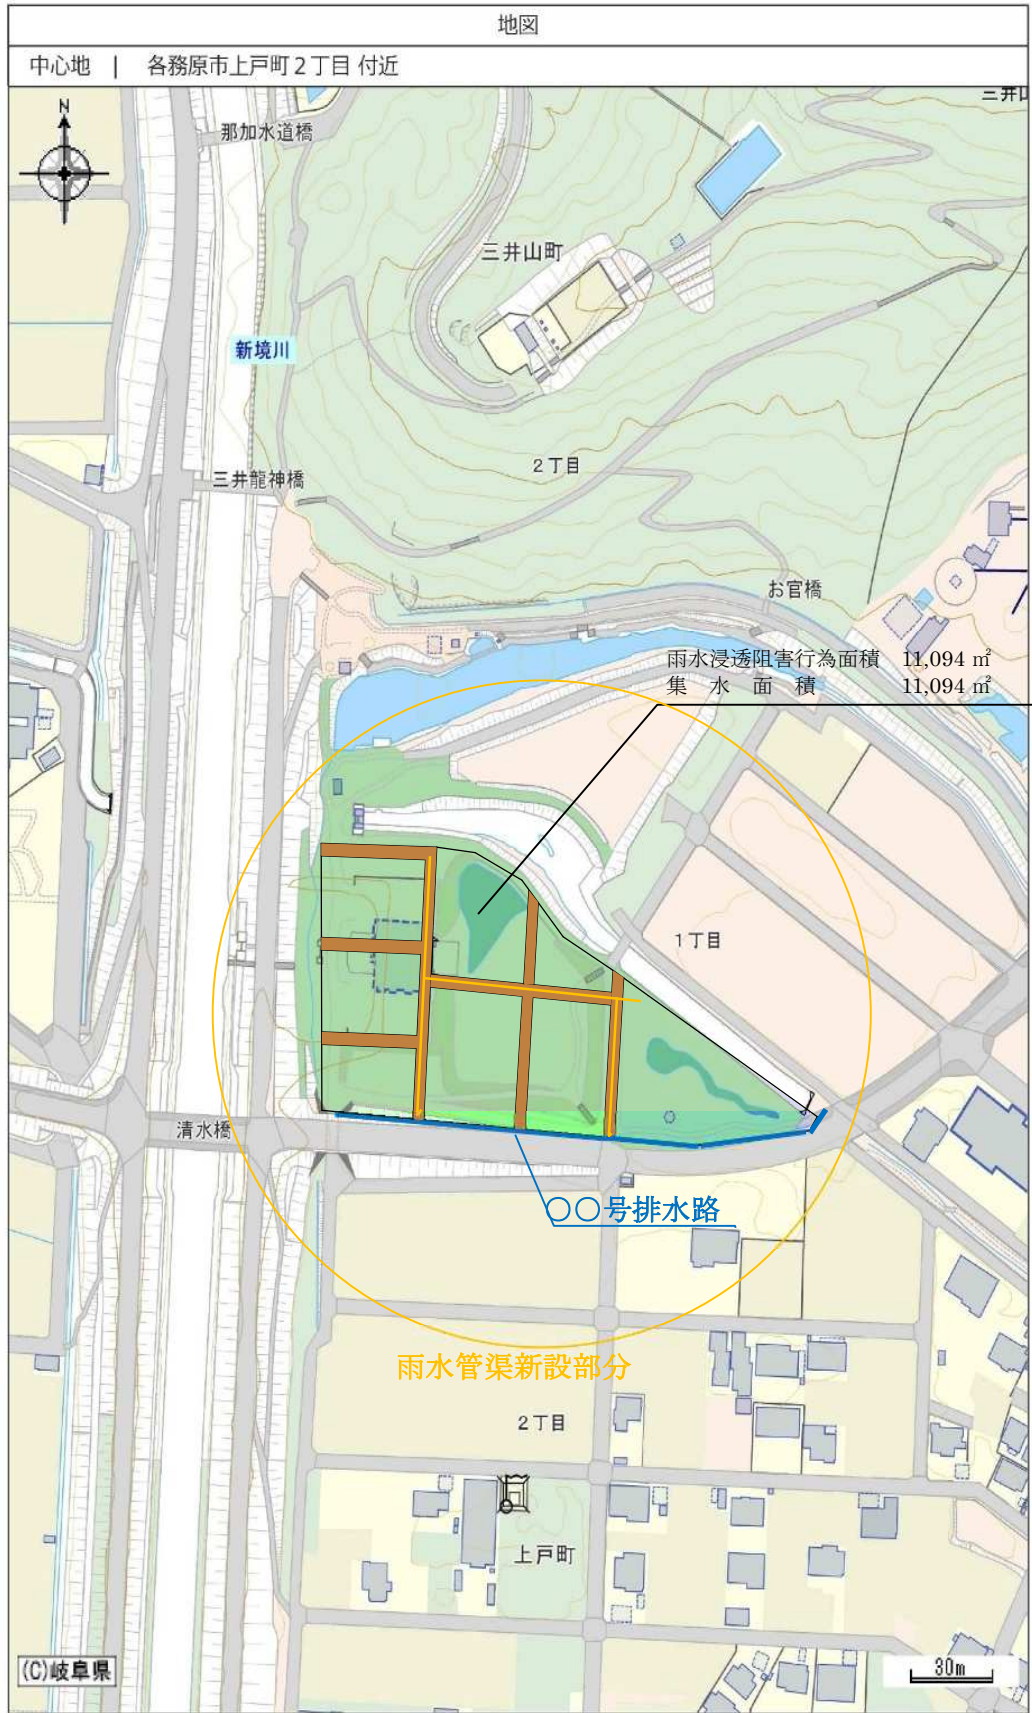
現況平面図(行為前)【縮尺 1/2, 500 以上】
